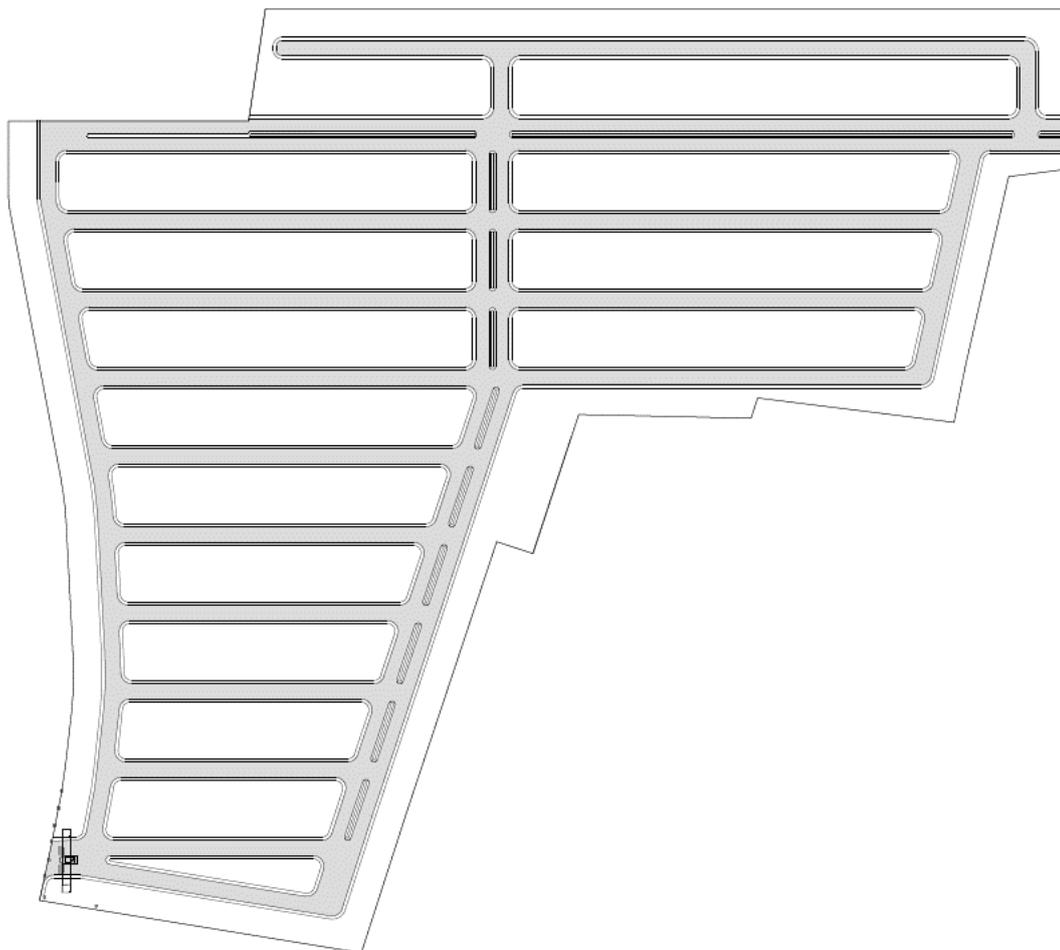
Planta Viabilidad Proyecto Cataluña / Elaboración: Igor Muñoz Arquitecto
